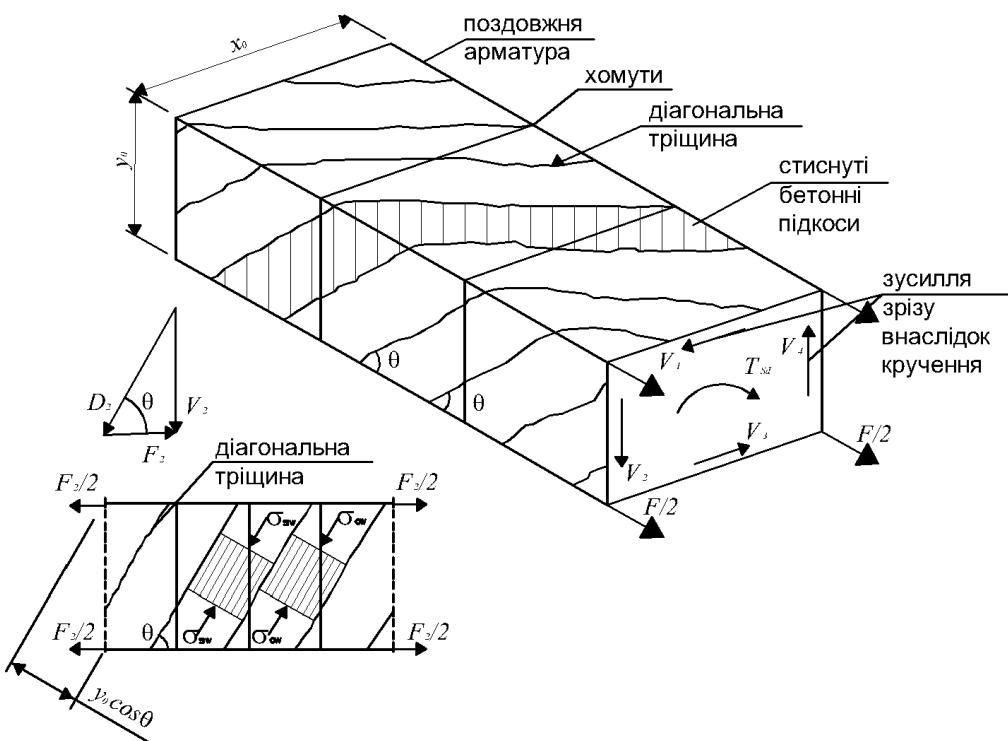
Розрахункова модель просторової ферми [69, 40]
